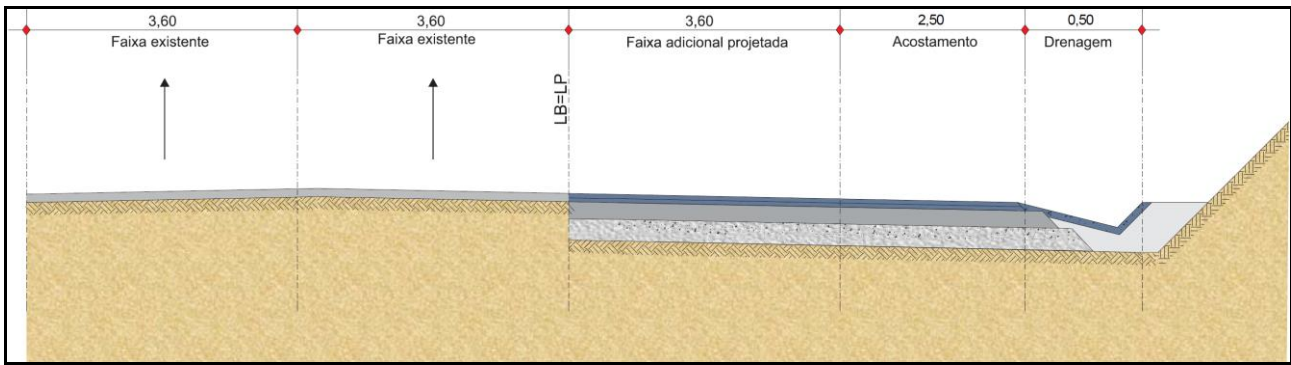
Seção Tipo - Implantação de Faixa Adicional.
